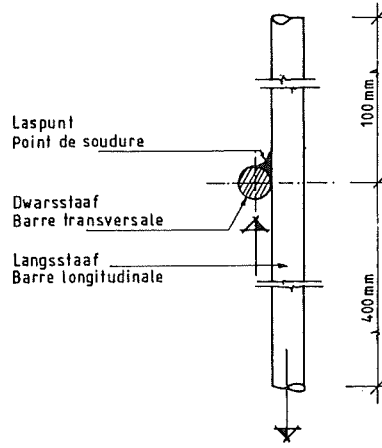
Essai d'arrachement - Positionnement de l'éprouvette.
